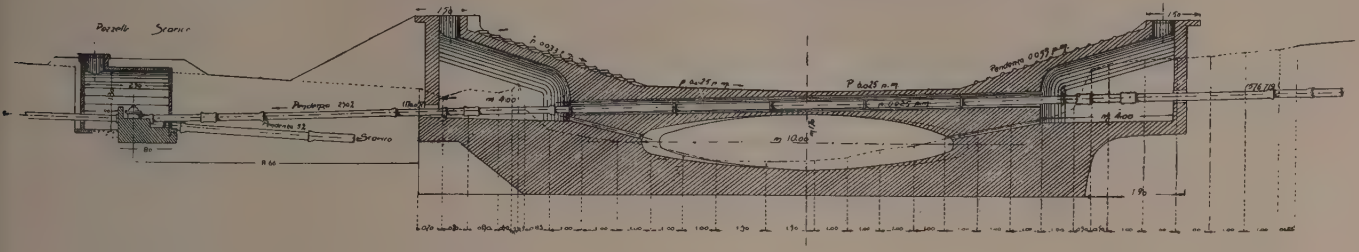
PASSAGGIO CON LA TUBAZIONE DI UN TORRENTE
